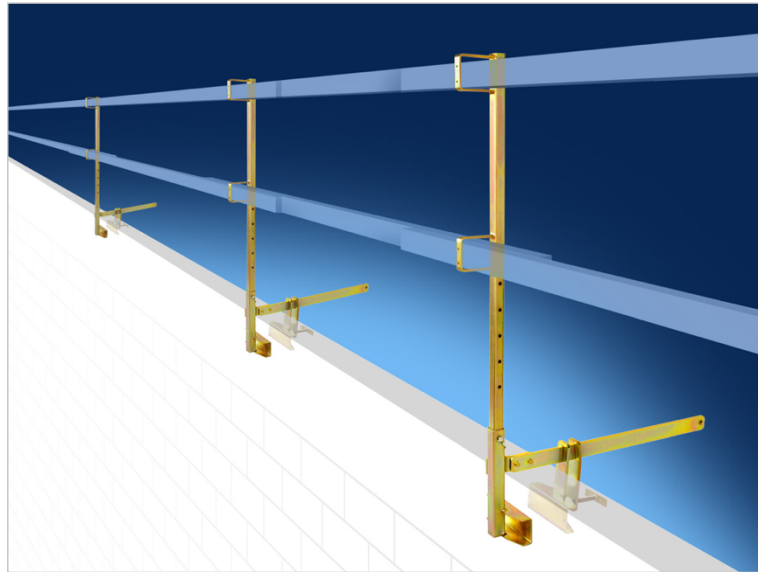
Parapetto temporaneo per protezione del bordo di copertura
